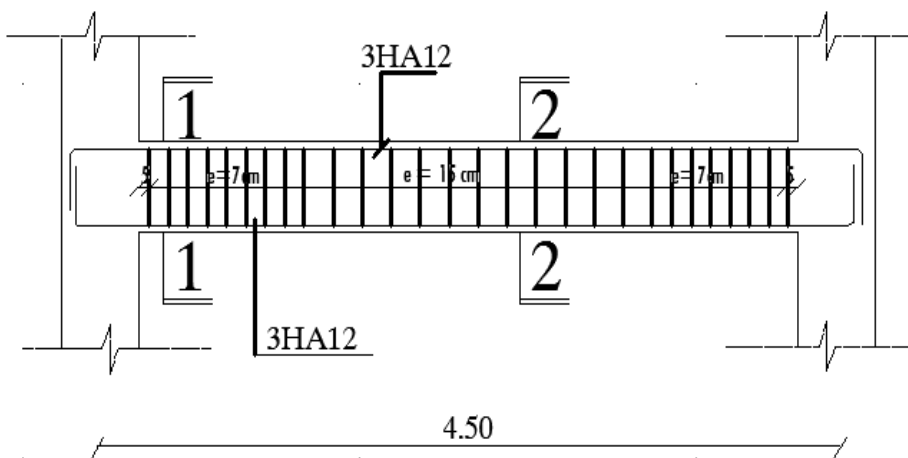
Schéma de ferrailage de la poutre de chaînage
